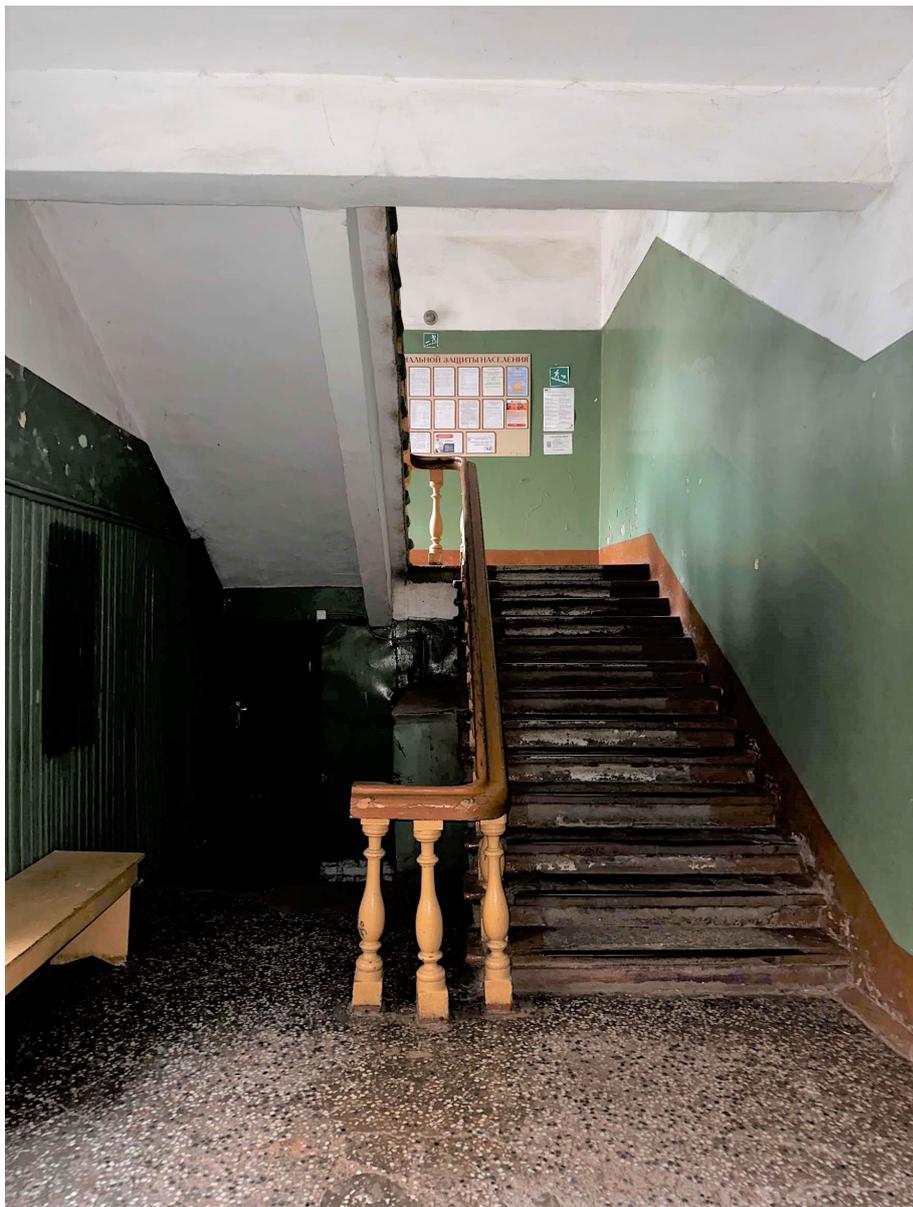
Северное крыло здания. 1-ый этаж. Общий вид лестничной клетки в западной части здания.
